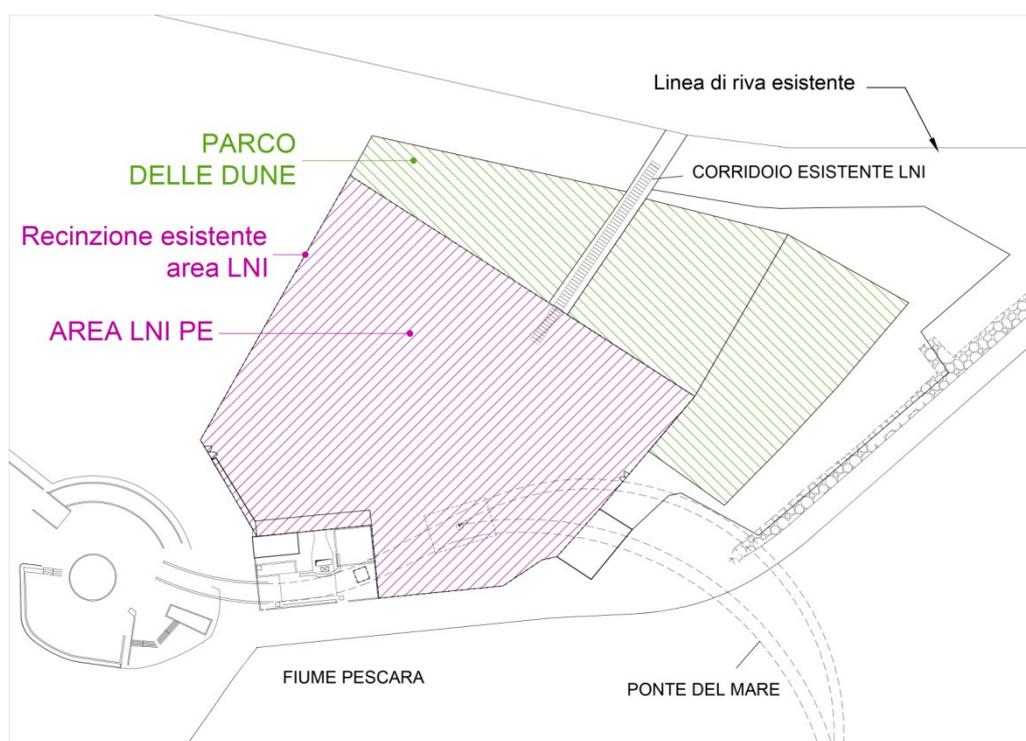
Perimetrazione del lotto di intervento rispetto al Parco delle Dune
